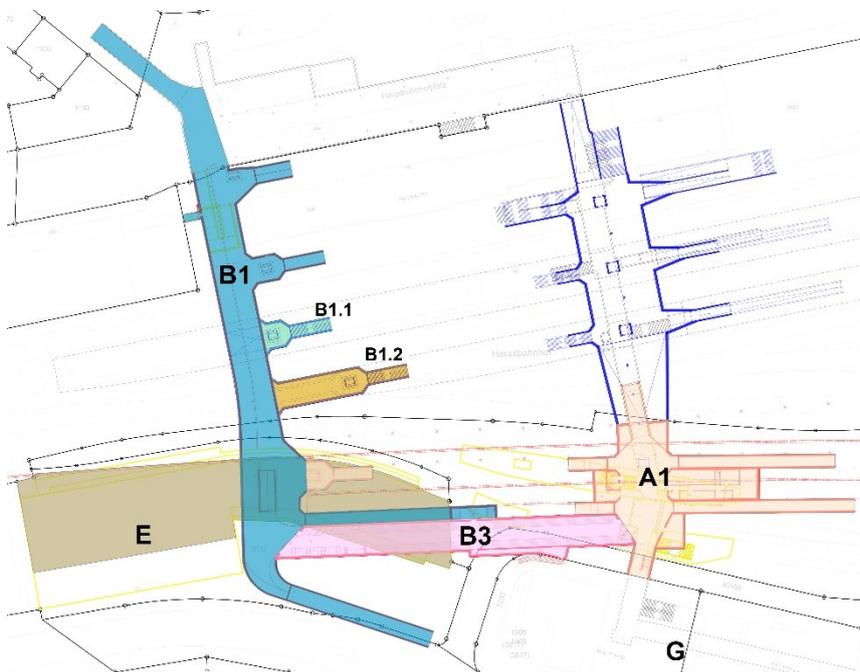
; Planausschnitt Situation auf Ebene Untergeschoss mit Darstellung der Module
